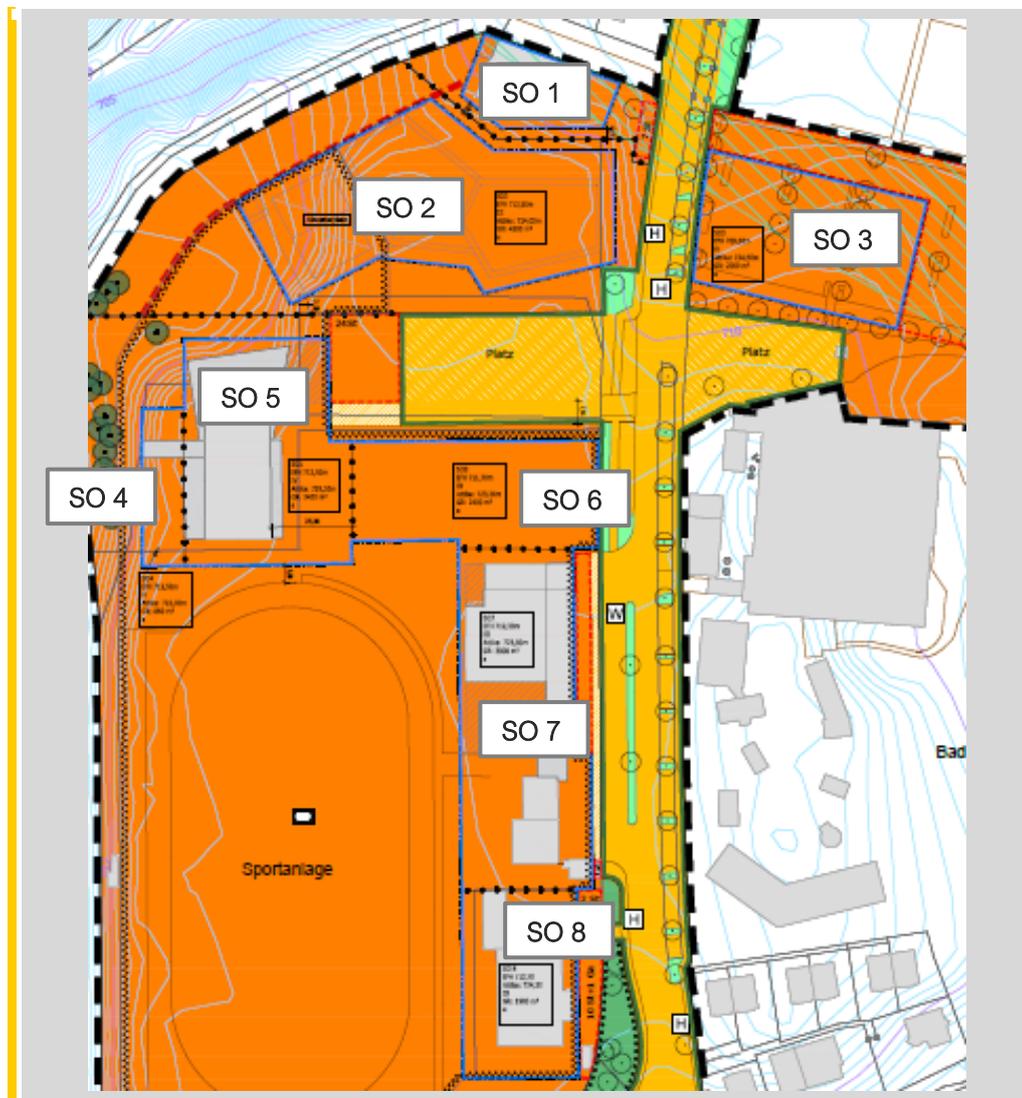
Flächenübersicht – Ausschnitt Bebauungsplan „10. Grundschule“
